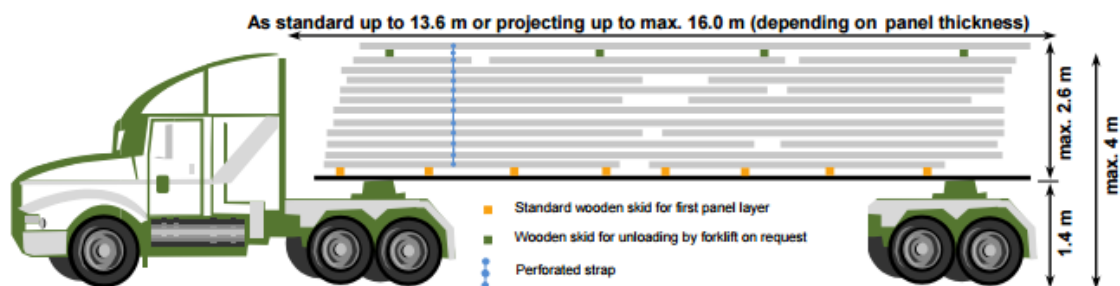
Dimensões de um caminhão com reboque articulado padrão utilizado para o transporte dos painéis CLT (Stora Enso – Technical Folder, 2015).
